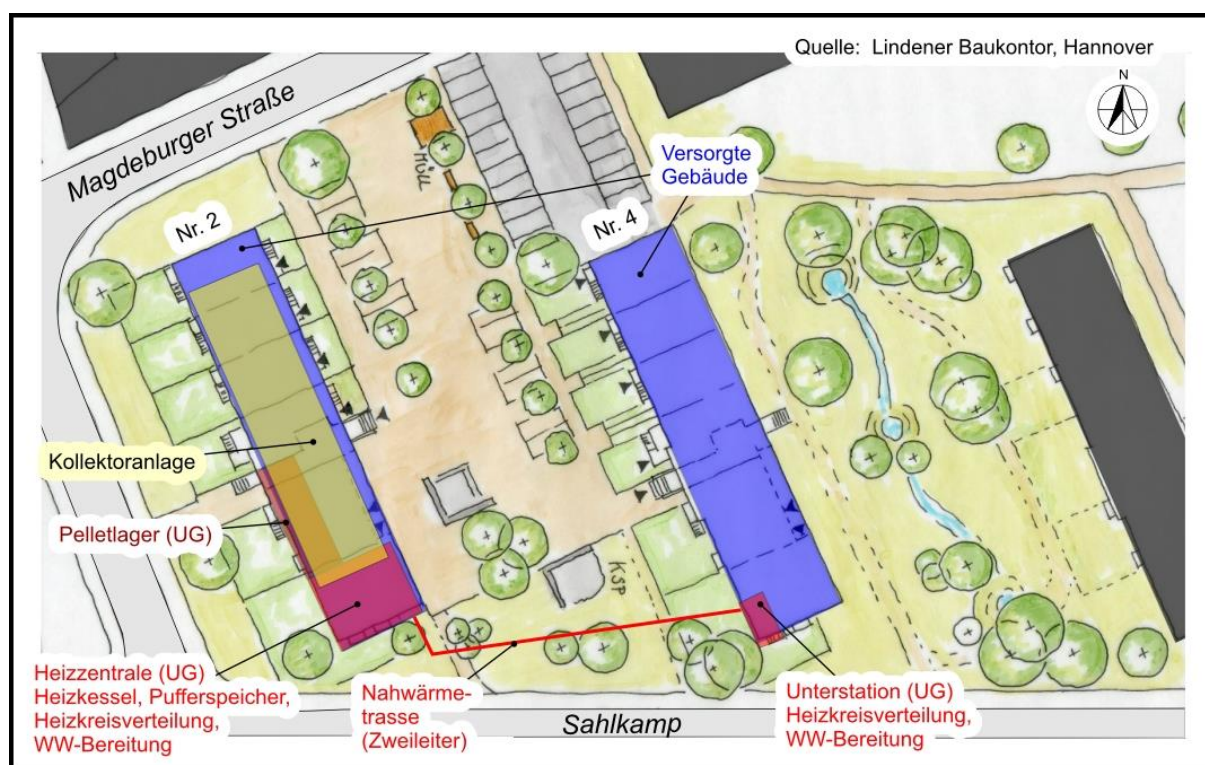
Lageplan Hannover, Magdeburger Straße 2 und 4
